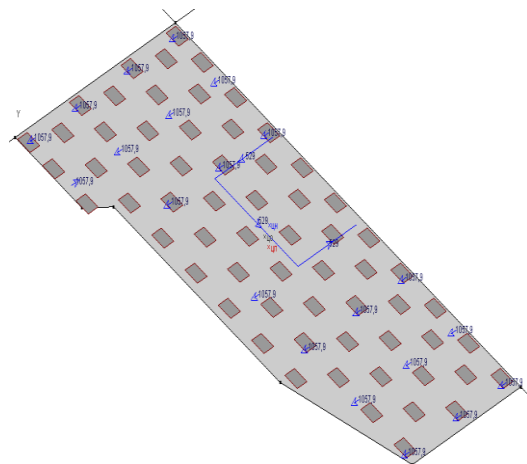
Расчётная схема фундаментной плиты для определения осадки закрепленного основания
